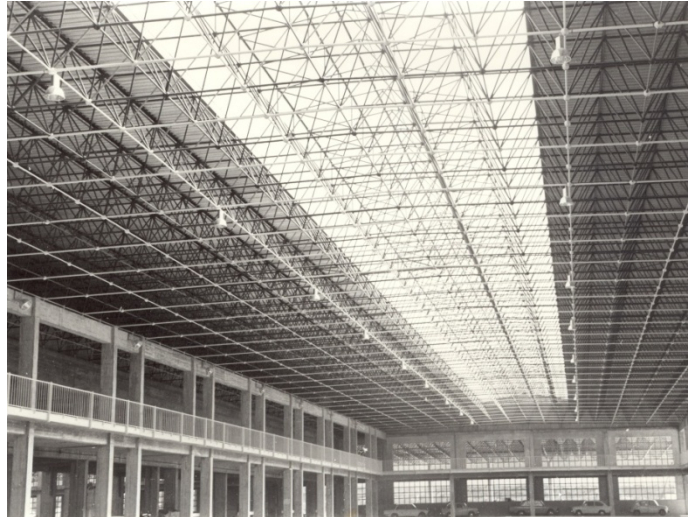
Perspectiva interior de la cubierta de la Nave nº 2. Pueden apreciarse en la parte izquierda los dos pórticos de hormigón paralelos de apoyo de la cubierta en uno de los lados.
